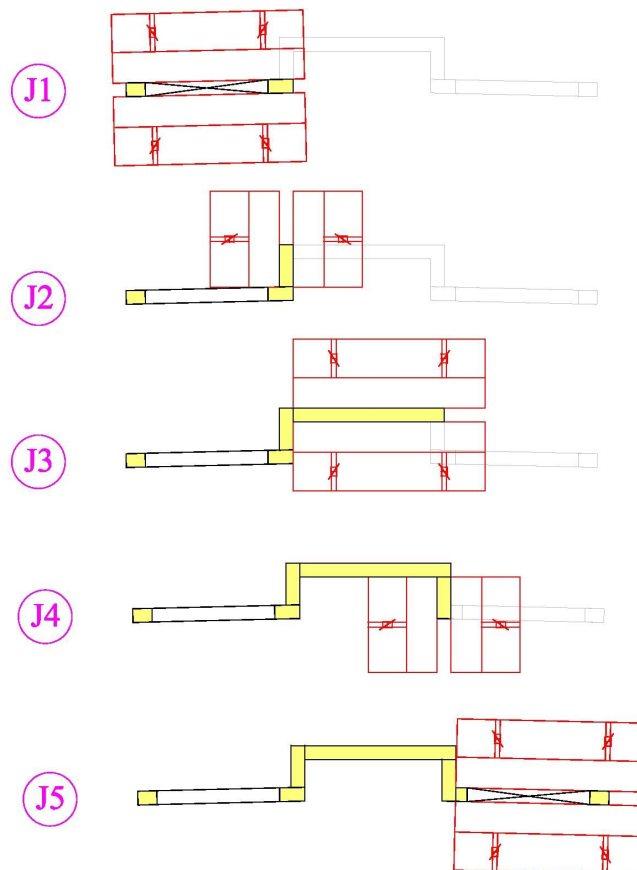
détail des décrochés en façade sur les plans de l'architecte et d'exécution
